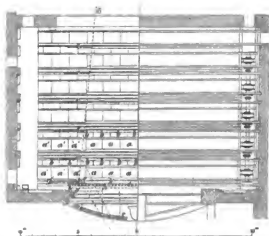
Grundriss der Bühne in Darmstadt.
